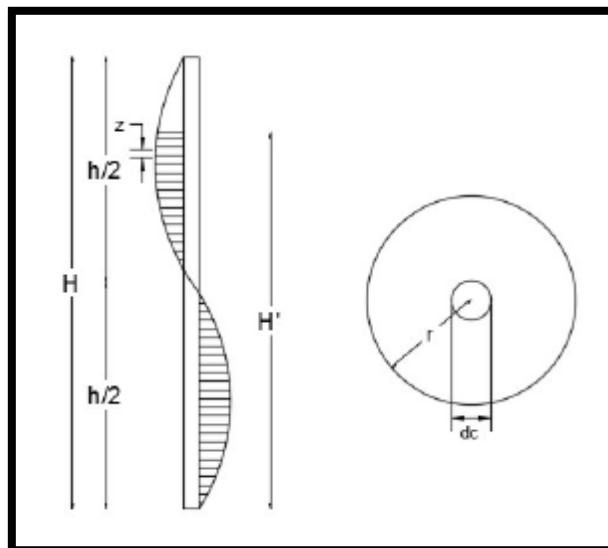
Vista en planta y perfil de escalera helicoidal con apoyo central. Alvarez (2017).
